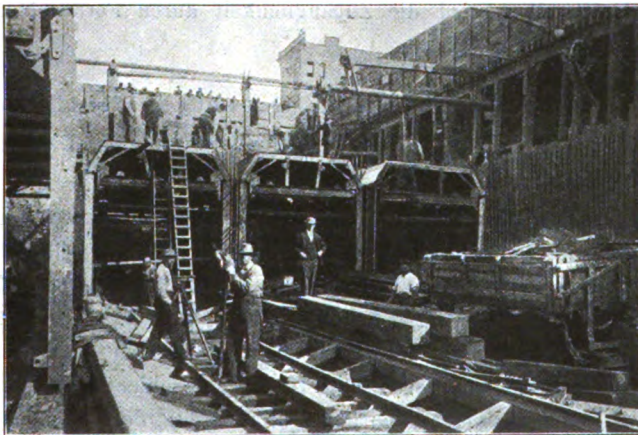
Bau der IV. Avenue-Untergrundbahn in Brooklyn. Anwendung beweglicher, eiserner Schalungen für den Betontunnel.
